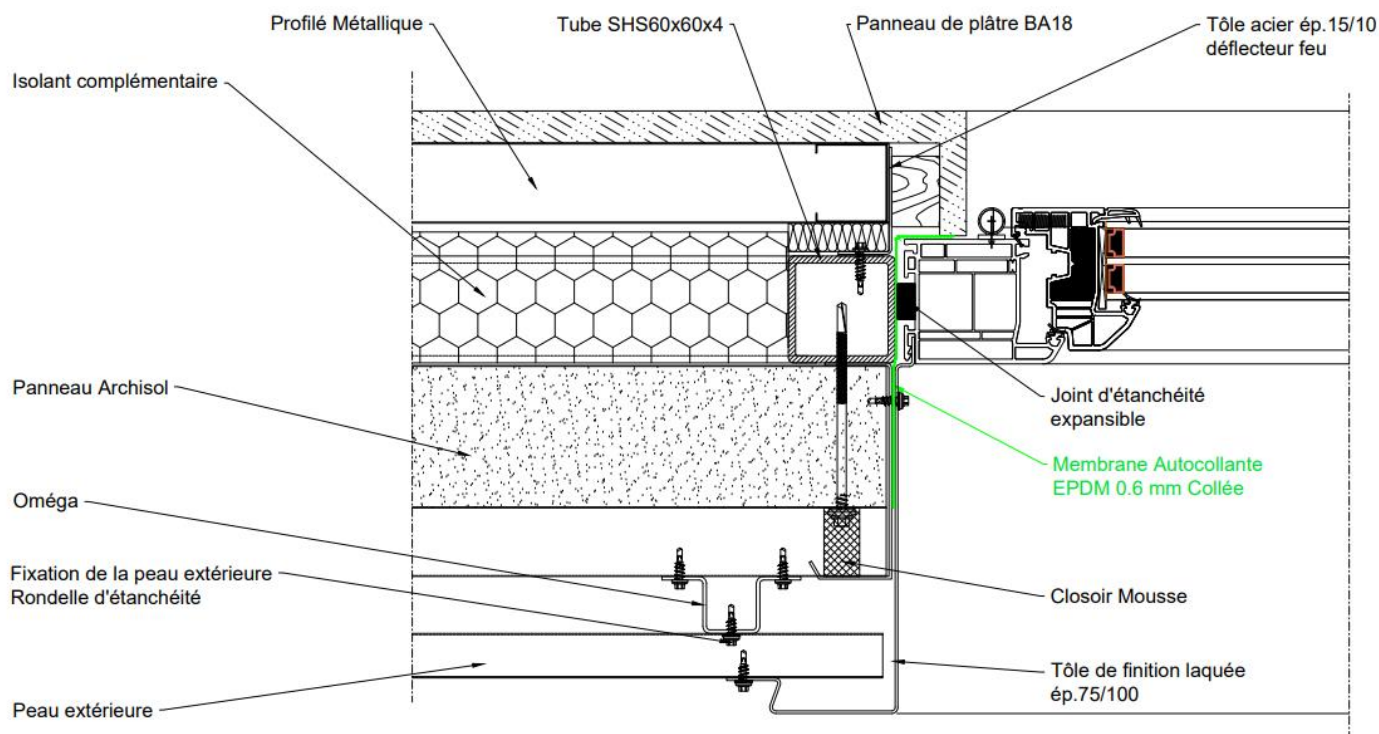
Coupe horizontale sur le jambage de fenêtre - D2B Archisol - Ossature en simple réseau.
